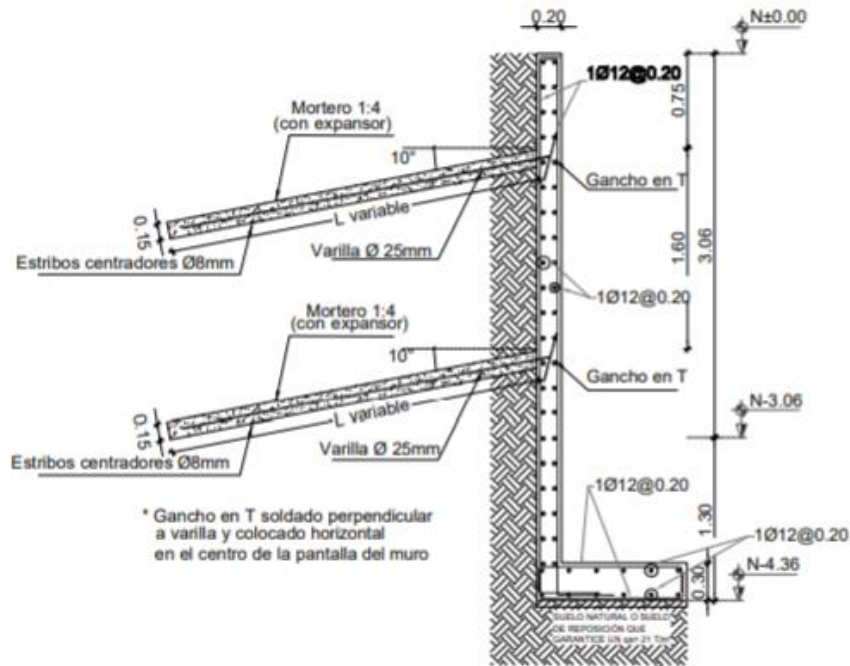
Sección del muro de contención. Elaboración propia, 2019.
